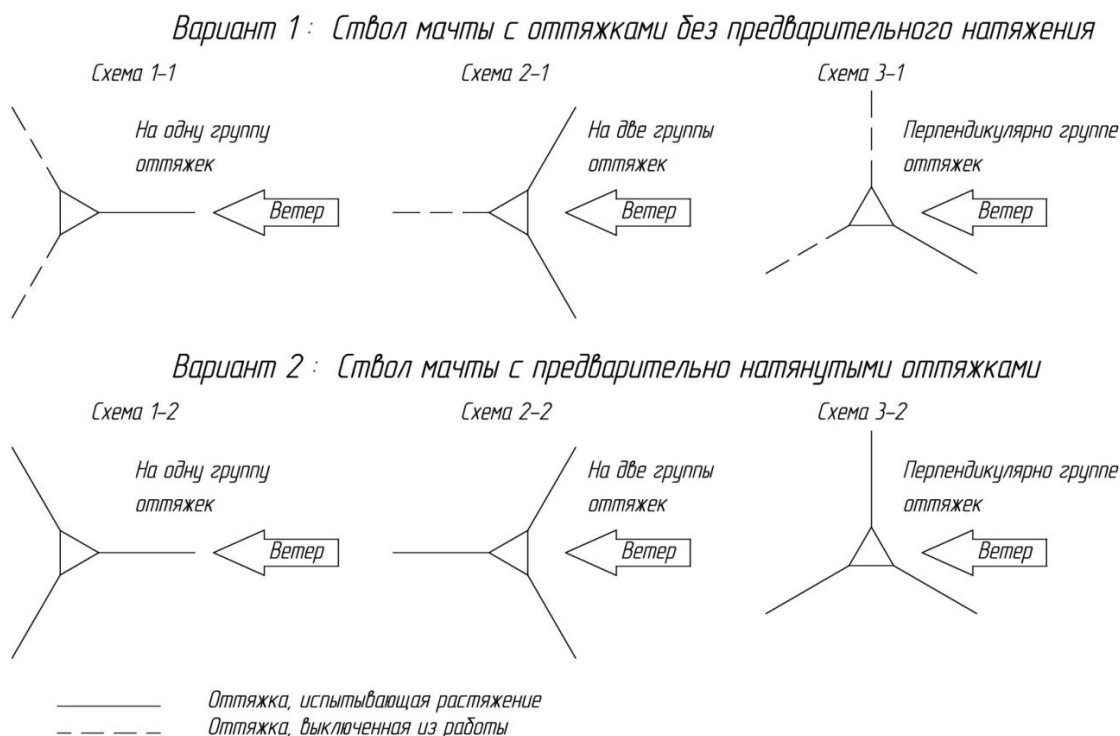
Схемы приложения к мачте ветровой нагрузки
